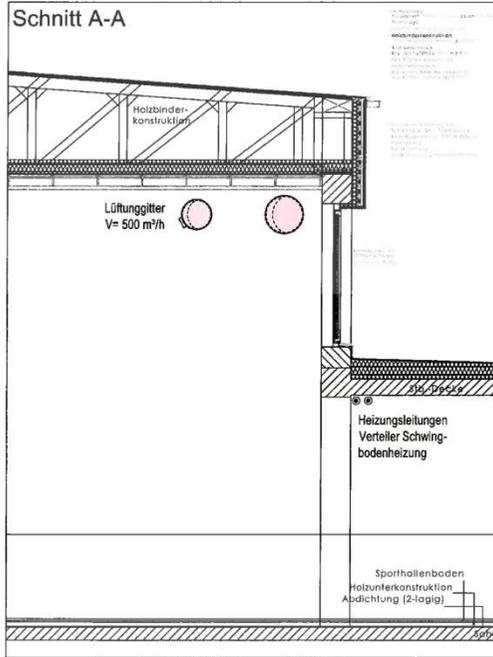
Schnitt Lüftungsrohre Zuluft Sporthalle
